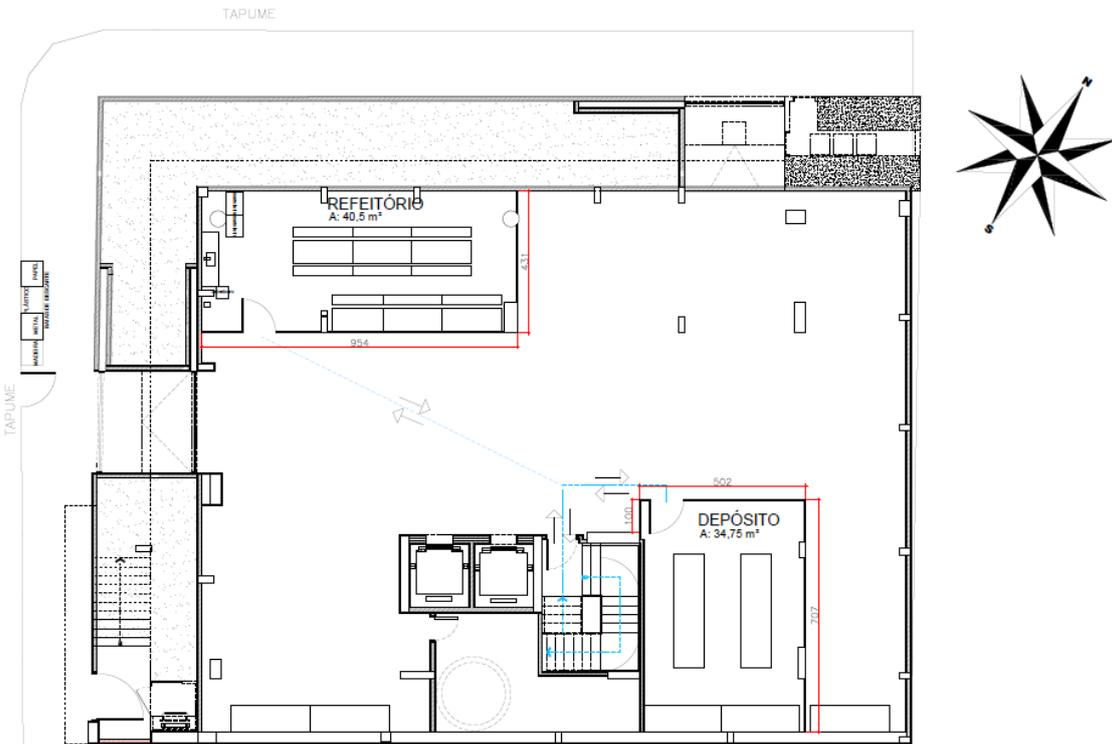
Canteiro de obras – obra 1, Subsolo.
